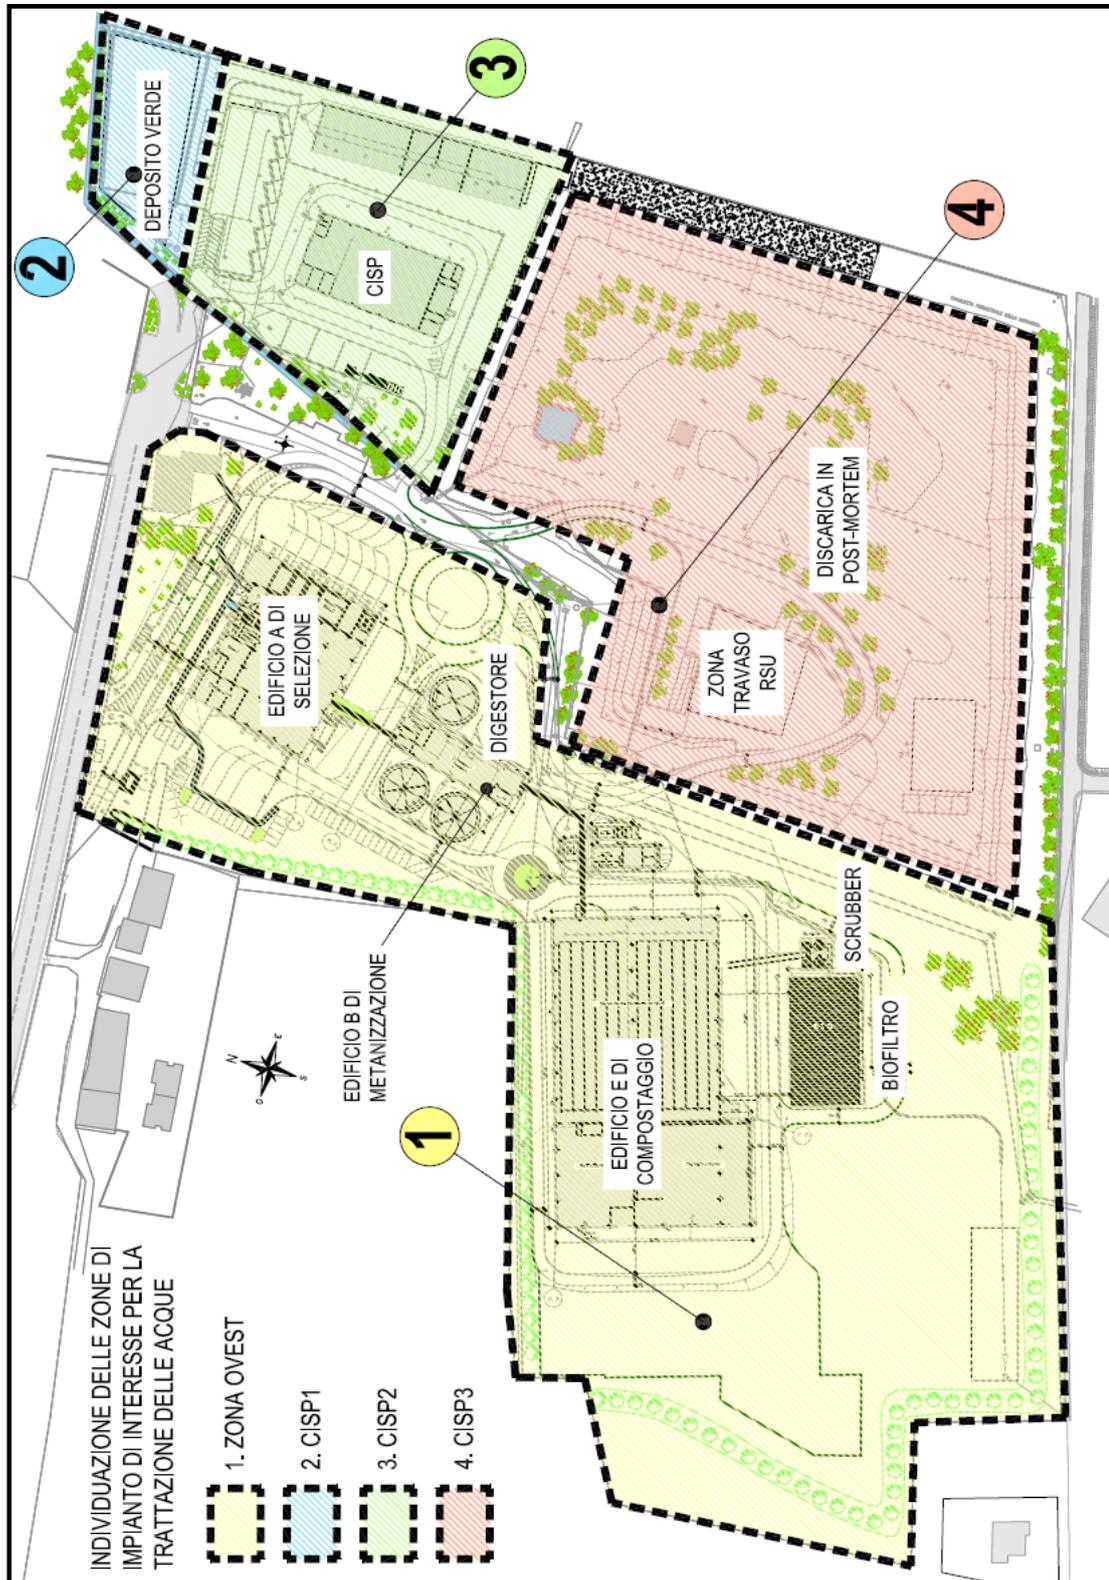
Suddivisione dell'area d'impianto nelle zone di specifico interesse (ante avvio lavori).
